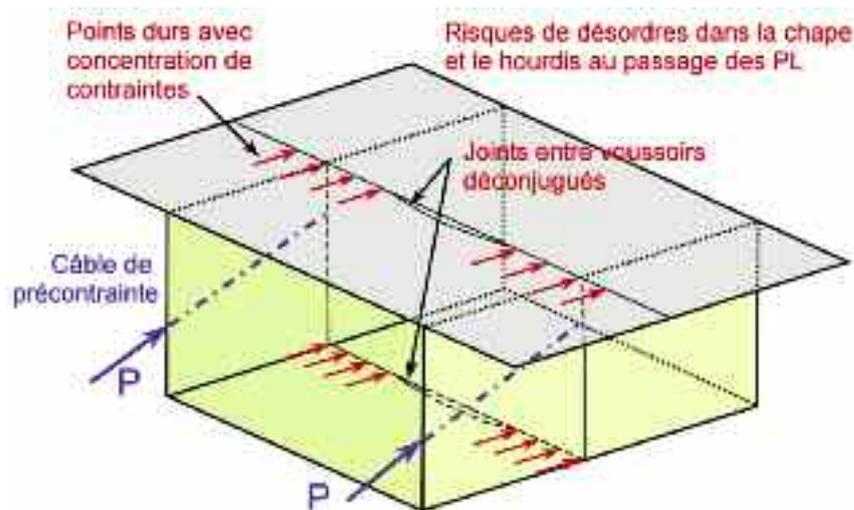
schéma montrant des zones de concentration de contraintes attirées par les points durs entre deux voussoirs - préfabriqués mal conjugués lors de la fabrication
